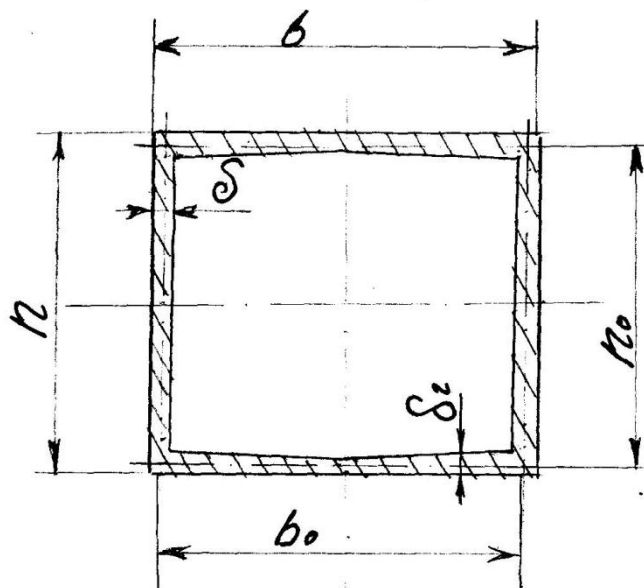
Розрахункова схема балки (поперечний переріз)
